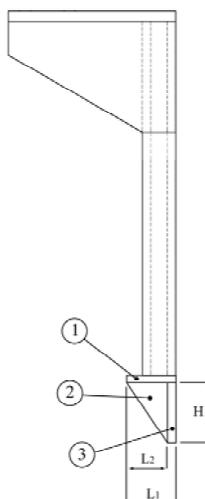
Dispositivo di attacco con disposizione verticale dei punti di ancoraggio (1 piastra orizzontale, 2 flangie di rinforzo, 3 piastra verticale)
